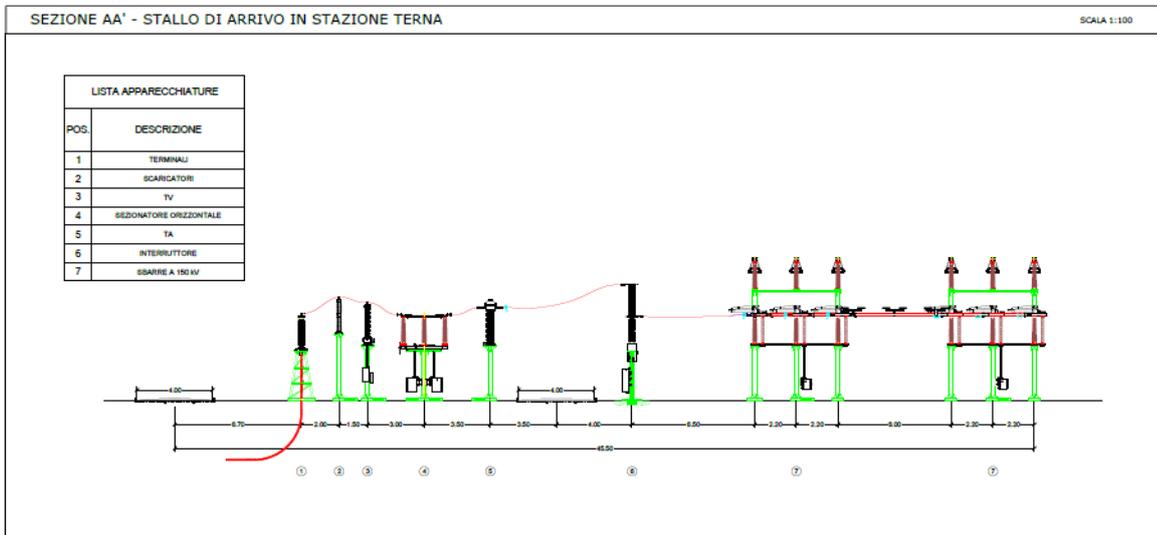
3 Sezione stallo di arrivo in stazione Terna
